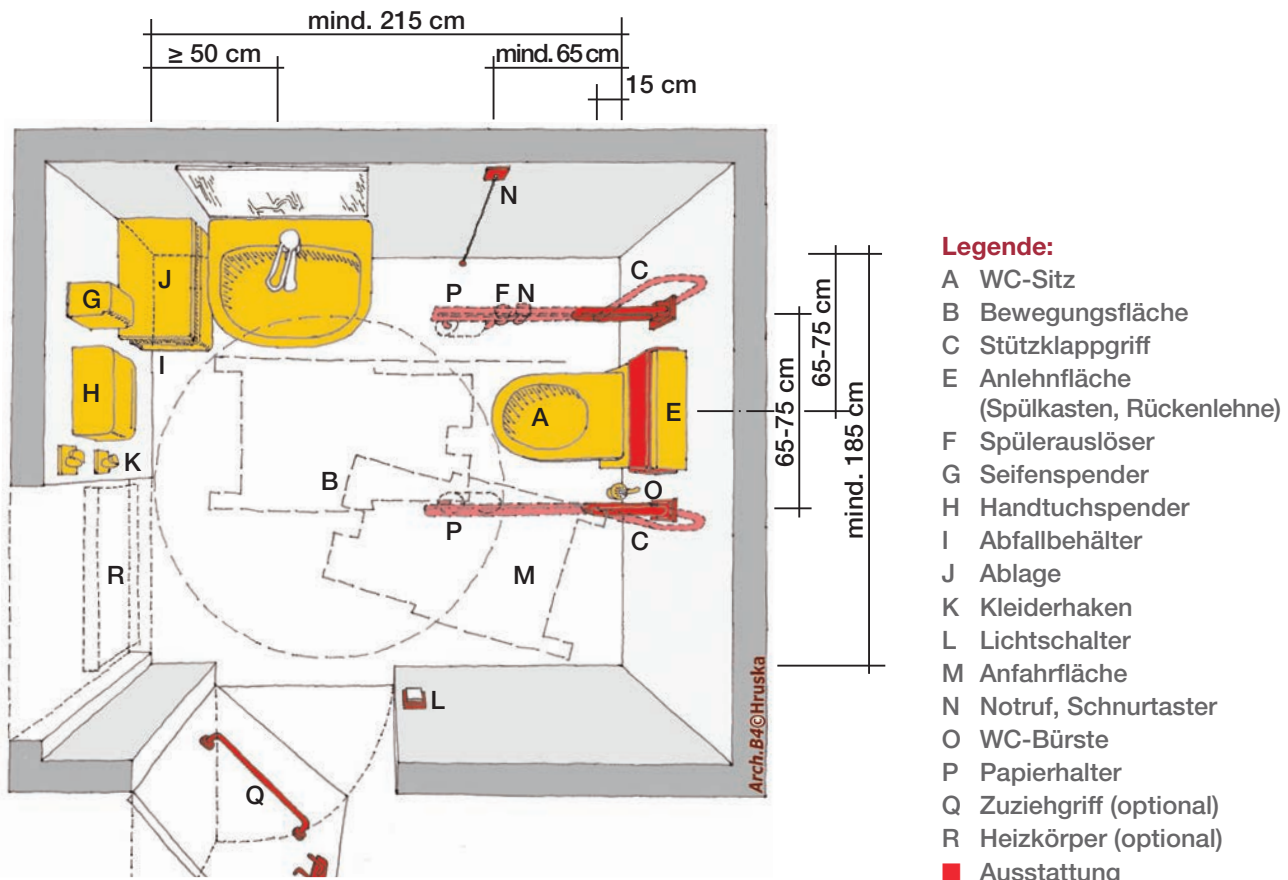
Grundriss zu Bild 1. WC-Anlage mit Handwaschbecken in Mindestgröße
